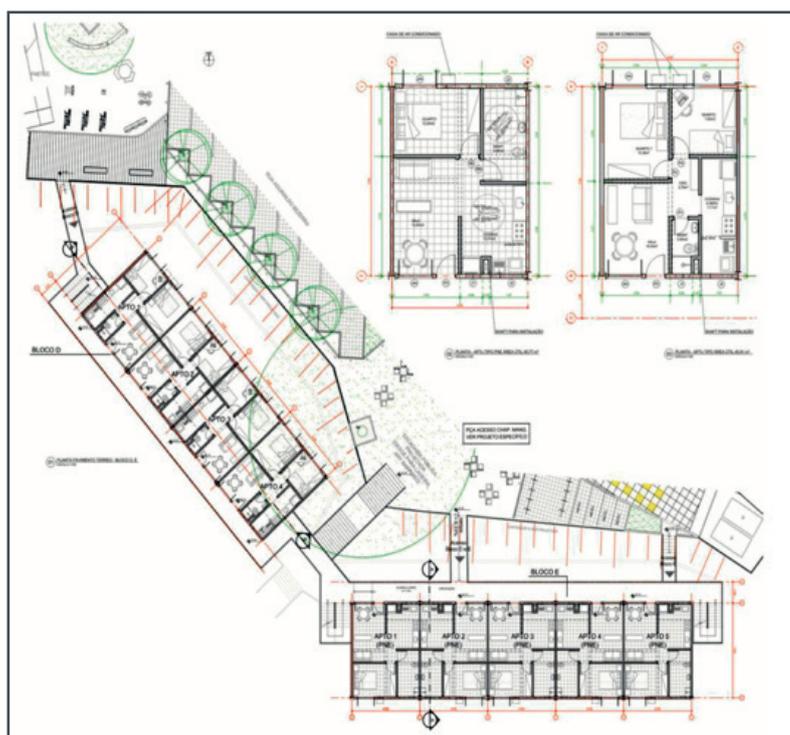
Planta Baixa (Pavimento Térreo HAB1)
